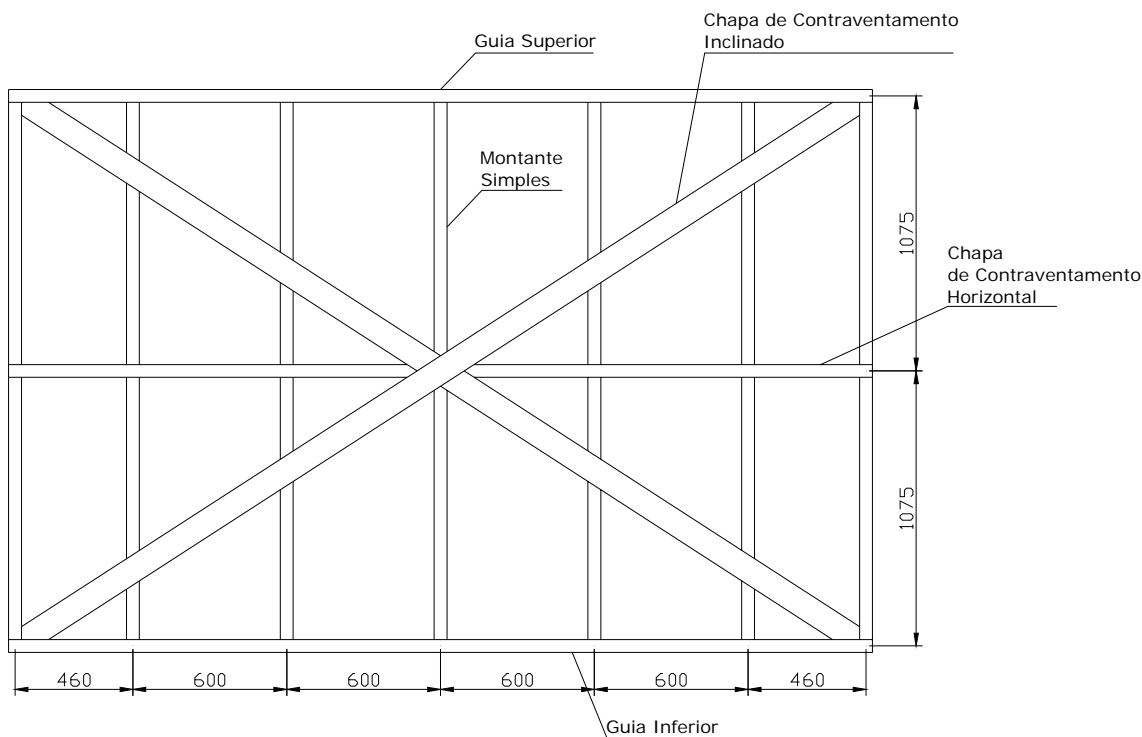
Parede estrutural “Steel-Frame” sem abertura
